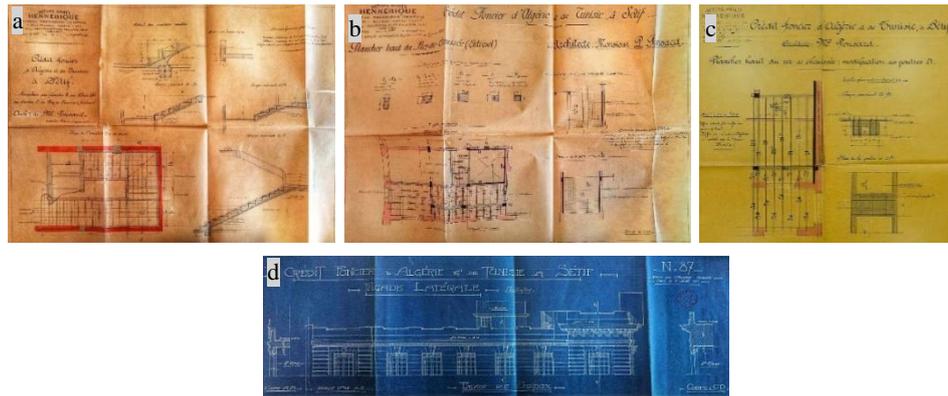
a) détail constructif d'escalier, b) détail constructif du plancher haut du RDC ;(c) détail constructif de poutre ;d) détail constructif de l'acrotère. (Centre d'archives d'architecture contemporaine)
